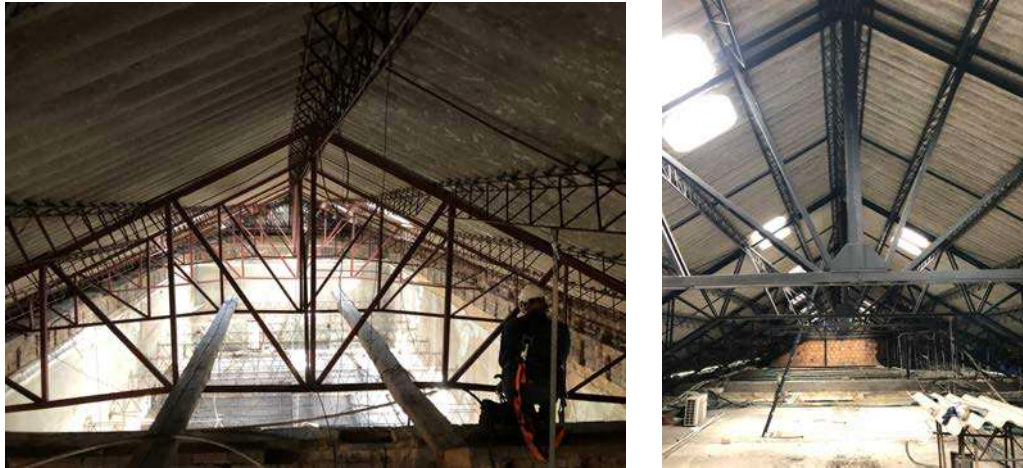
y 113: Estructura de cubierta crujía oriental. Estructura de cubierta crujía norte.
